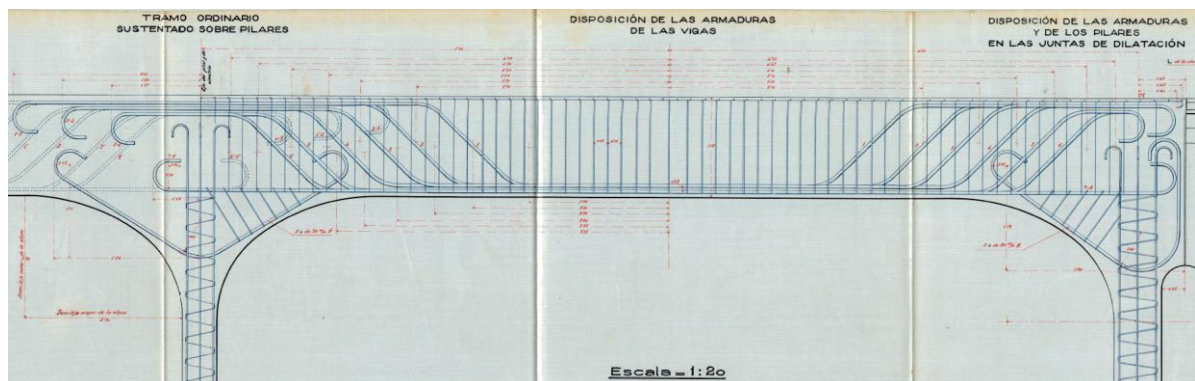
Disposición del armado longitudinal de la viga [12]
